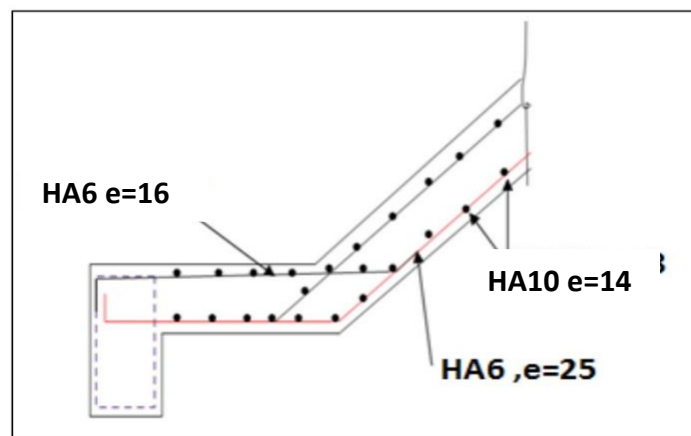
Ferrailage de l'escalier 2em..8em étage
